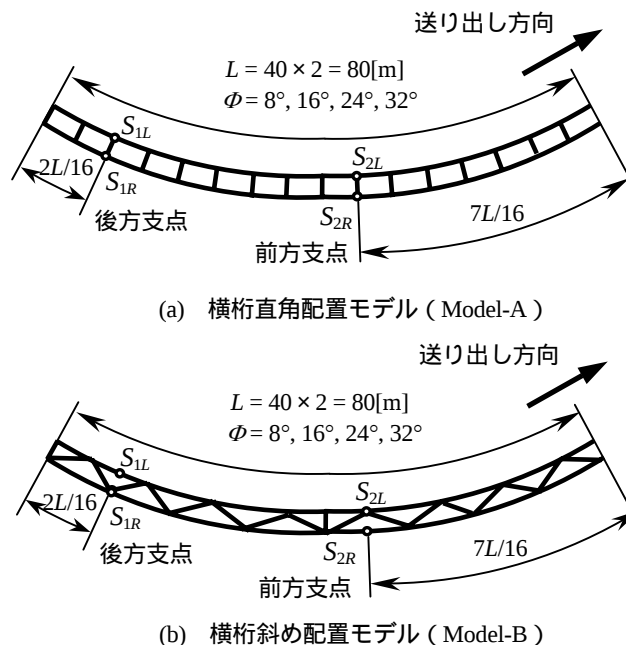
曲線2主桁橋送り出し架設系モデル（平面図）
